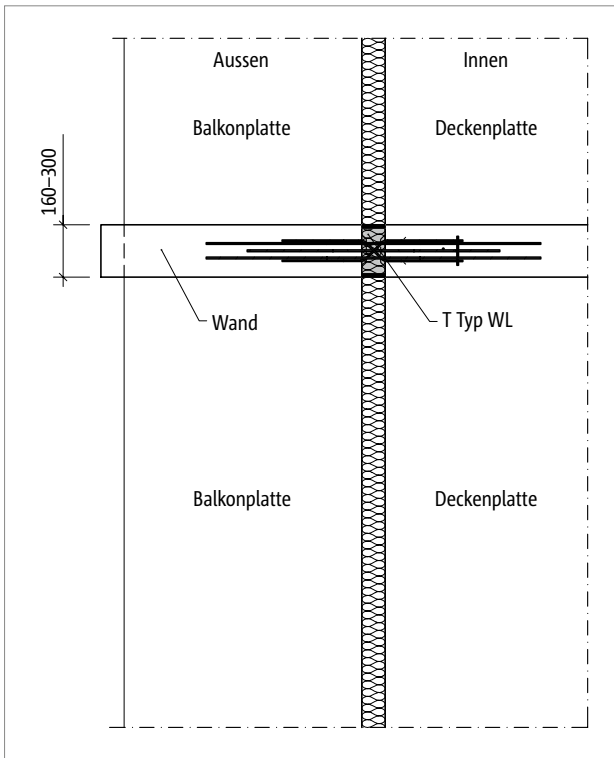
Schöck Isokorb® T Typ WL: Grundriss; Balkonkonstruktion mit wärmegeämmten tragenden Wandscheiben
